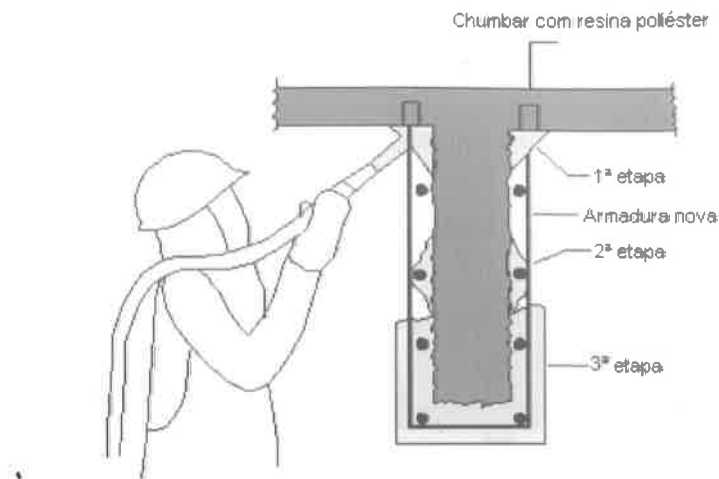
Reforço de flexão em vigas com concreto projetado.
